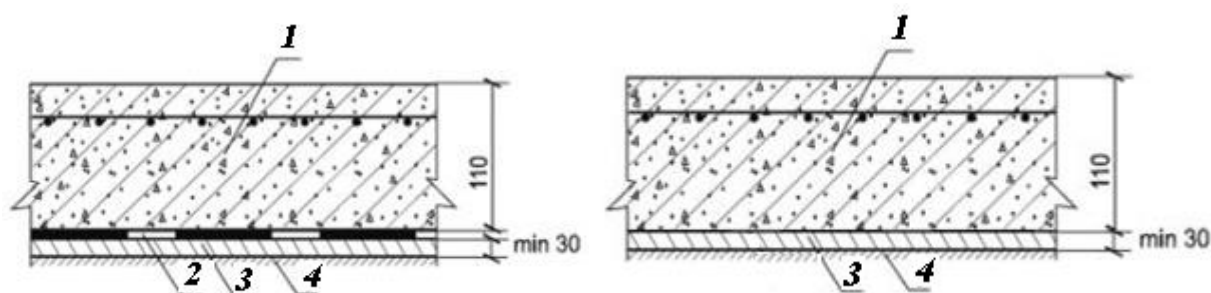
Конструкція дорожнього одягу мосту із застосуванням цементобетонного покриття
